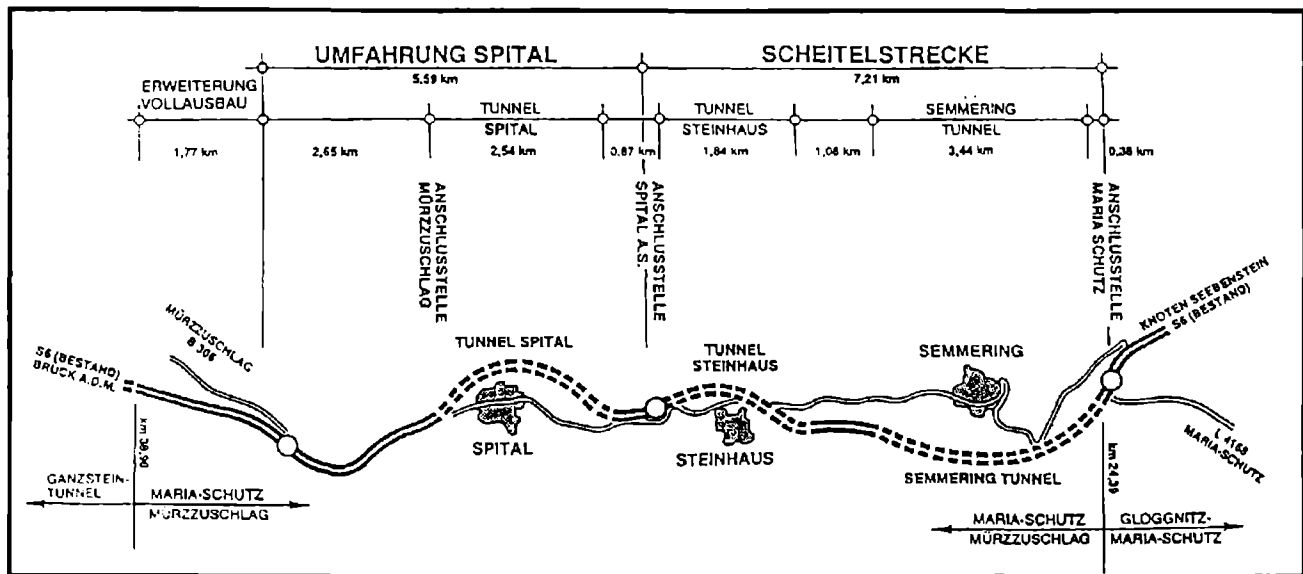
Übersichtslageplan der drei Tunnelstrecken im Abschnitt des Lückenschlusses über den Semmering im Bereich Greis-Maria Schutz (NÖ.) und Grautschenhof (STMK).
